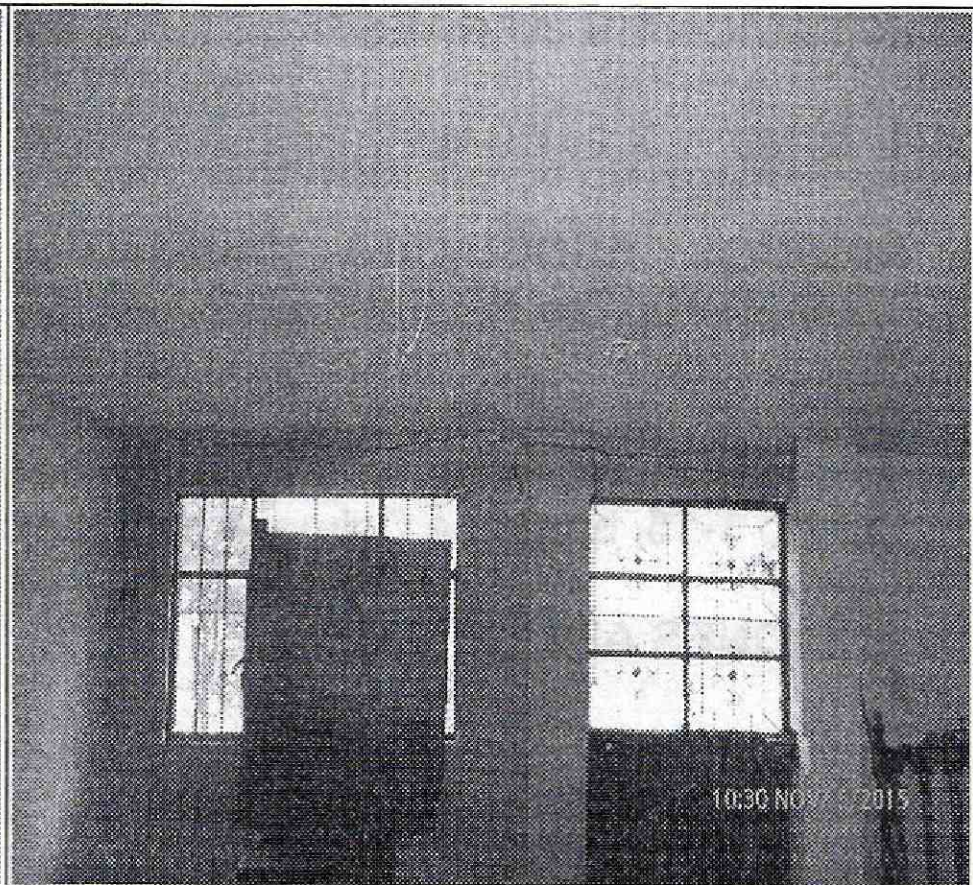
y 4 Vista del interior del predio de la Calle 37 Sur No 1-09, barrio La Colmena de la Localidad San Cristóbal y el costado nor-occidental del mismo se observan grietas de tendencia diagonal escalonada en el muro de cerramiento de longitud cercana a los 2m y aberturas de 2 cm.
